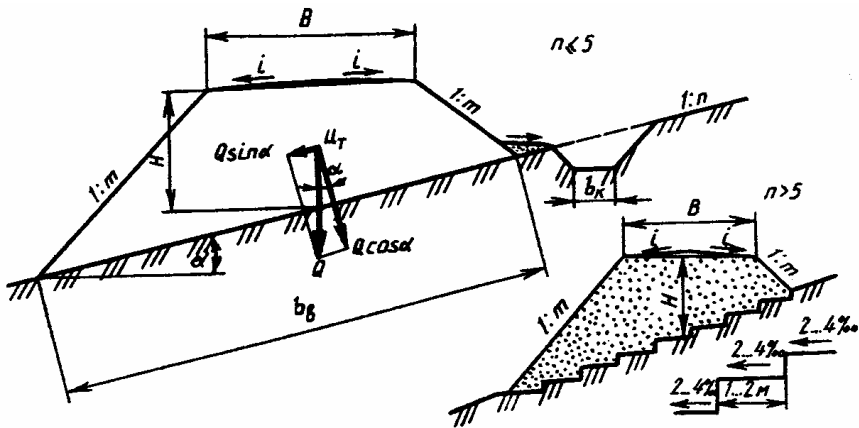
Расчетная схема для определения коэффициента устойчивости насыпи на косогоре
